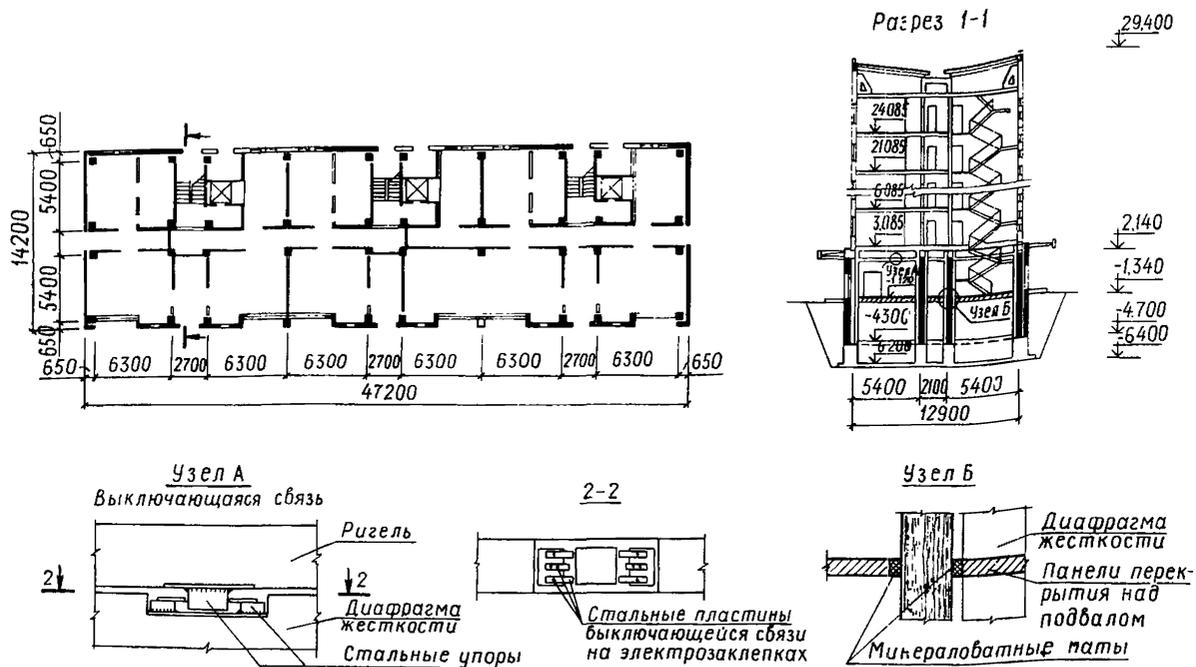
Крупнопанельное здание на железобетонных стойках в первых двух этажах с выключающимися связями и диафрагмами жесткости (проект разработан Таджикгипростроем совместно с ЦНИИСК им.В.А.Кучеренко)
